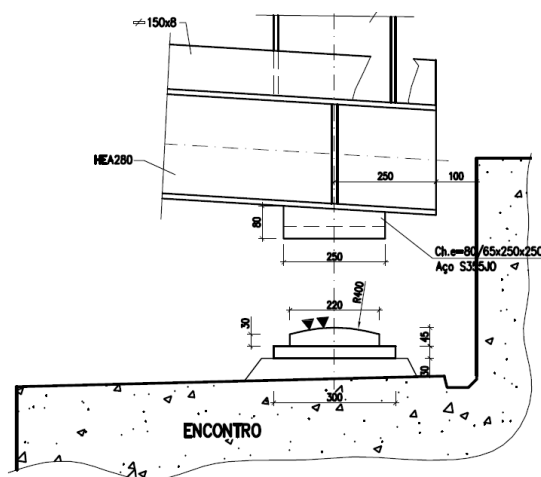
Pormenor do apoio deslizante num dos encontros [25].
